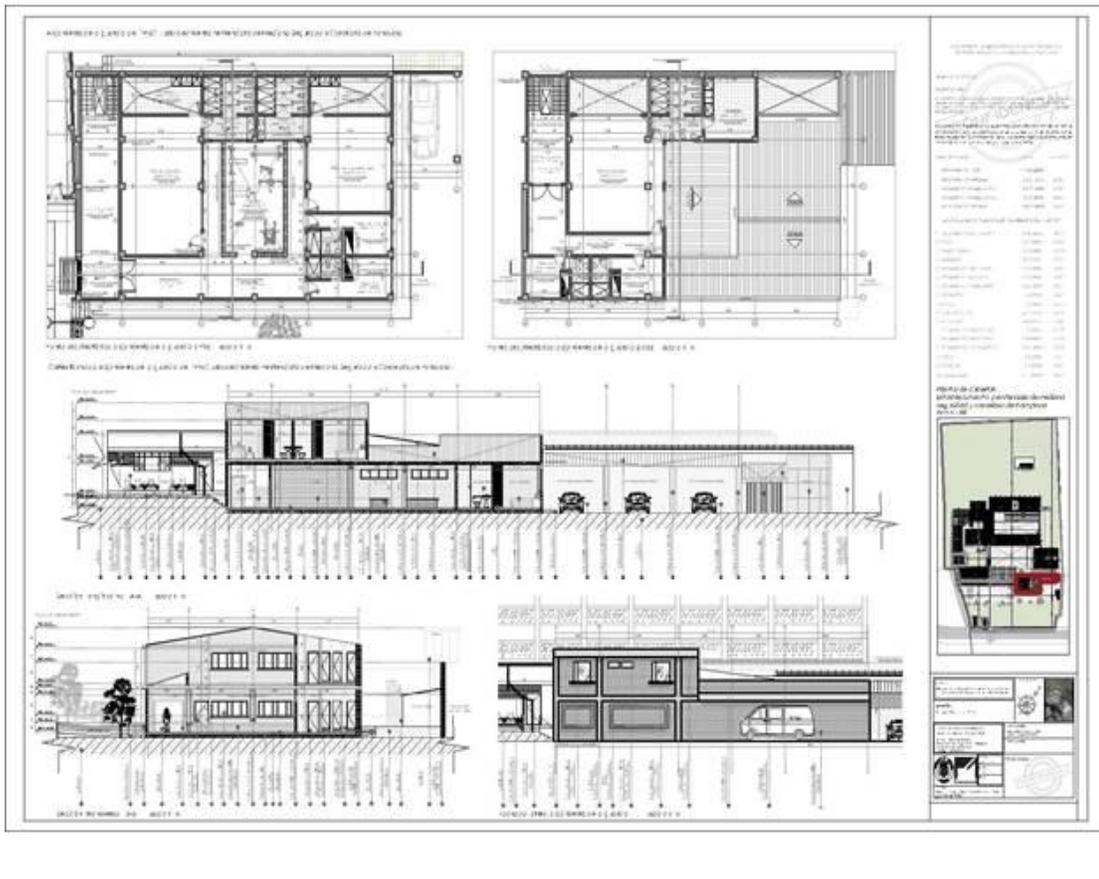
Plantas arquitectónicas alojamiento de la guardia del INPEC
